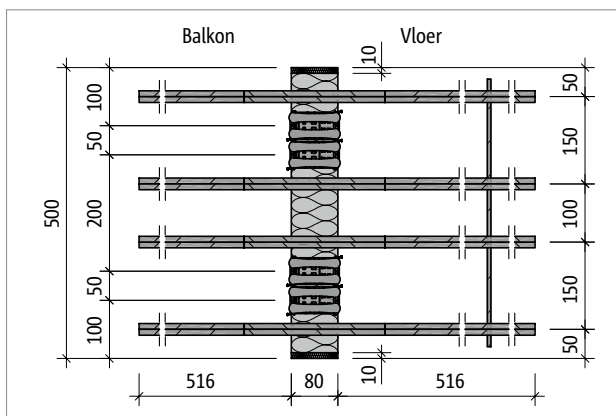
Schöck Isokorf® T type Q-E-W-VV5: Bovenaanzicht
